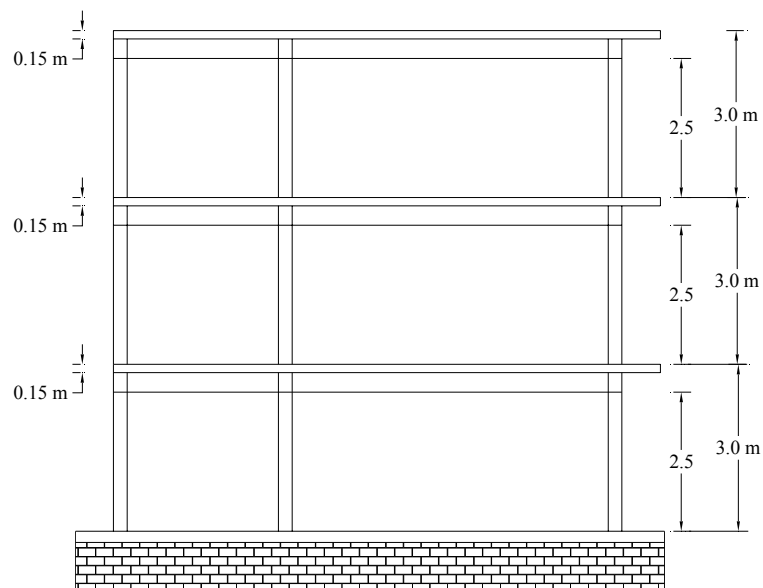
Vista (nel piano XZ) dell'edificio
